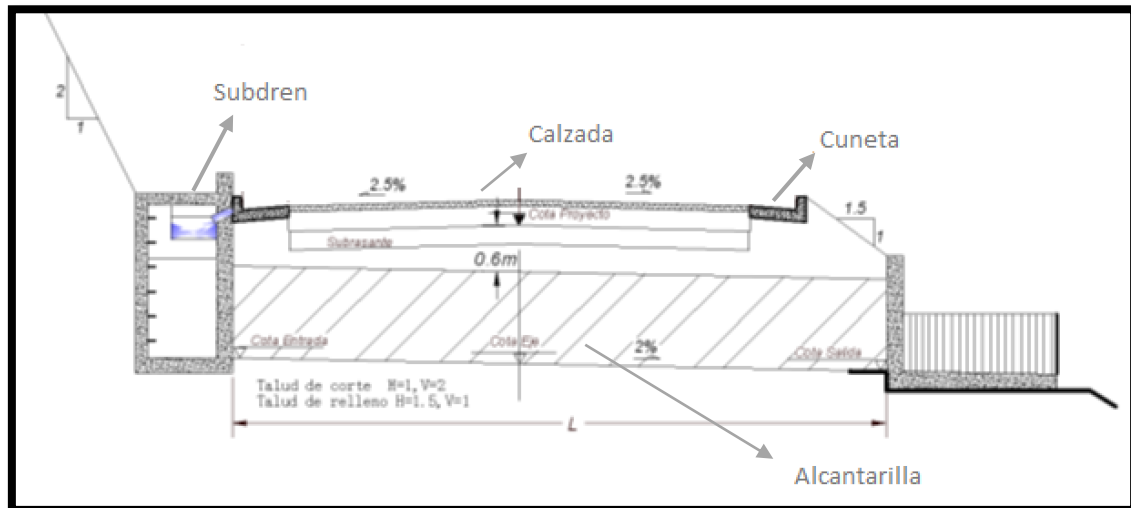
Sistema de drenaje vial (Fuente: Luis Bañon Blázquez).
